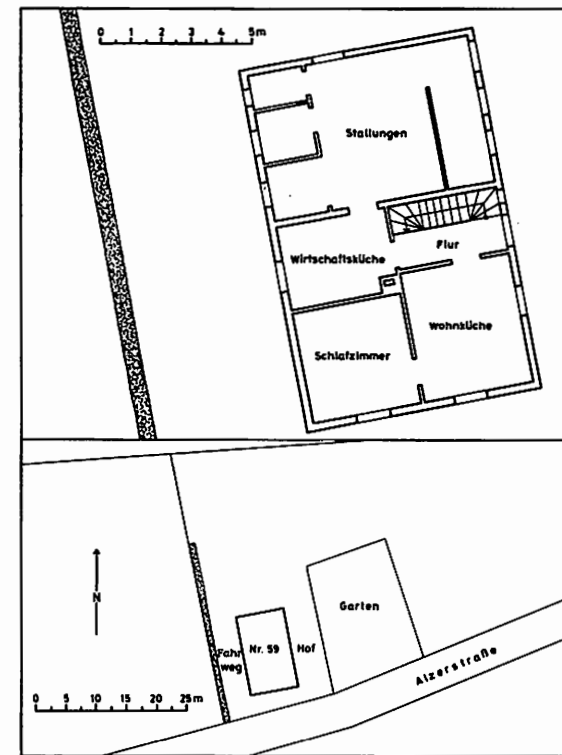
Lageplan und Erdgeschoßgrundriß des Gebäudes mit Haus-schutzhecke in Monschau-Höfen, Alzerstraße 59 (gezeichnet nach der bei der Kreisverwaltung Aachen, Nebenstelle Monschau, vorliegenden Bauakte).
